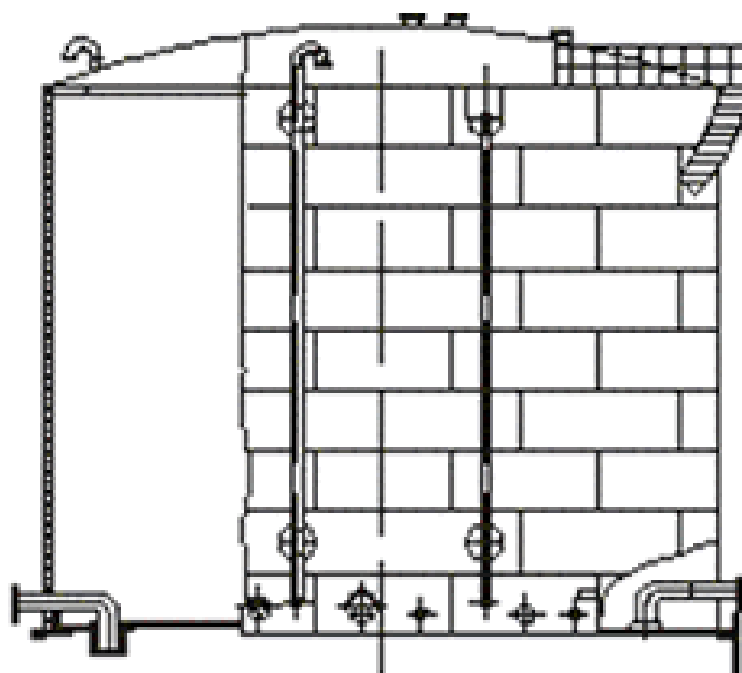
Цилиндрический сварной стальной резервуар со сферической крышей и винтовой лестницей
